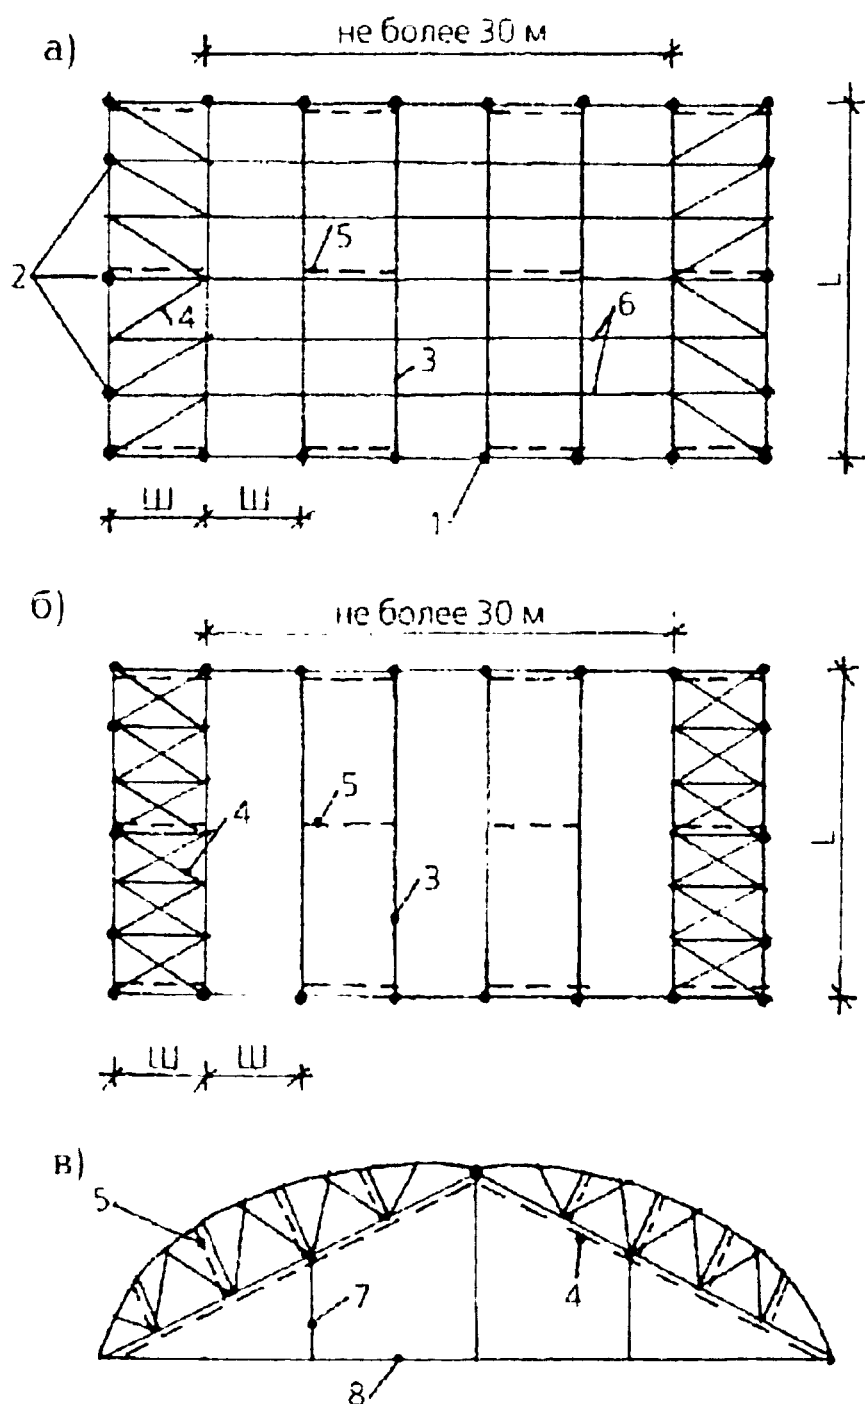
Деревянный каркас. Связи в покрытии: а - связи по верхнему поясу ферм; б - связи по нижнему поясу ферм; в - расположение связей в покрытии с трехшарнирными сквозными арками; 1 - стойки каркаса; 2 - стойки фахверка; 3 - несущие конструкции покрытия; 4 - горизонтальные связи; 5 - вертикальные связи; 6 - прогоны; 7 - подвеска; 8 - затяжка
